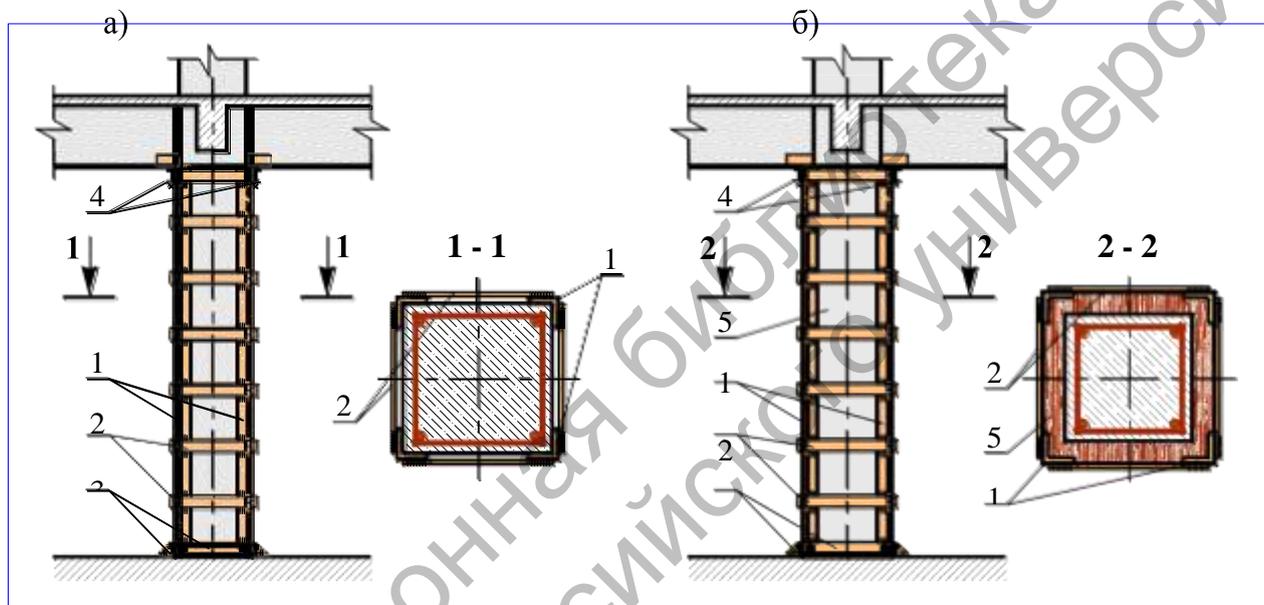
Схемы стальных обойм, используемые при усилении железобетонных колонн: а – стальная обойма без обетонирования; б – стальная обойма с обетонированием; 1 – продольные элементы стальной обоймы; 2 – поперечные элементы стальной обоймы; 3 – опорные уголки; 4 – упорные элементы; 5 – обетонирование
